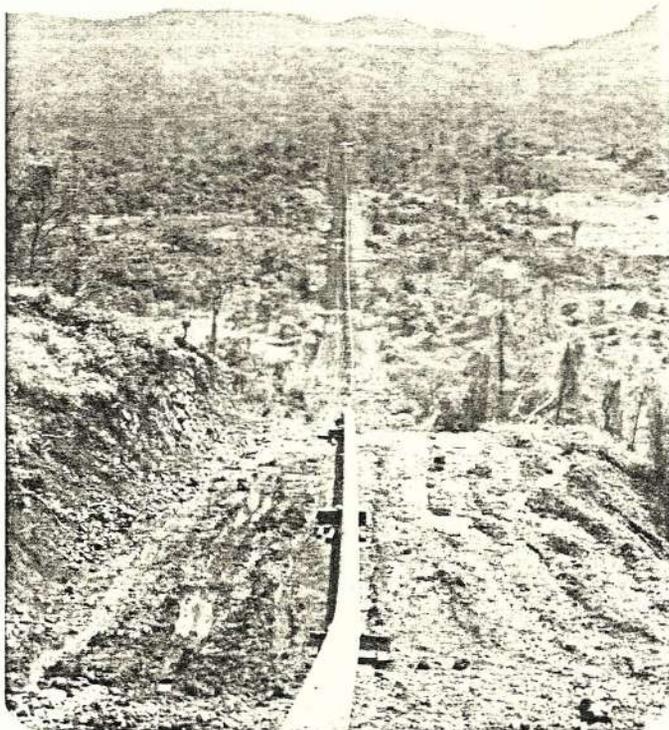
Vista parcial del poliducto una vez ejecutadas las uniones de soldadura y la inspección visual.
